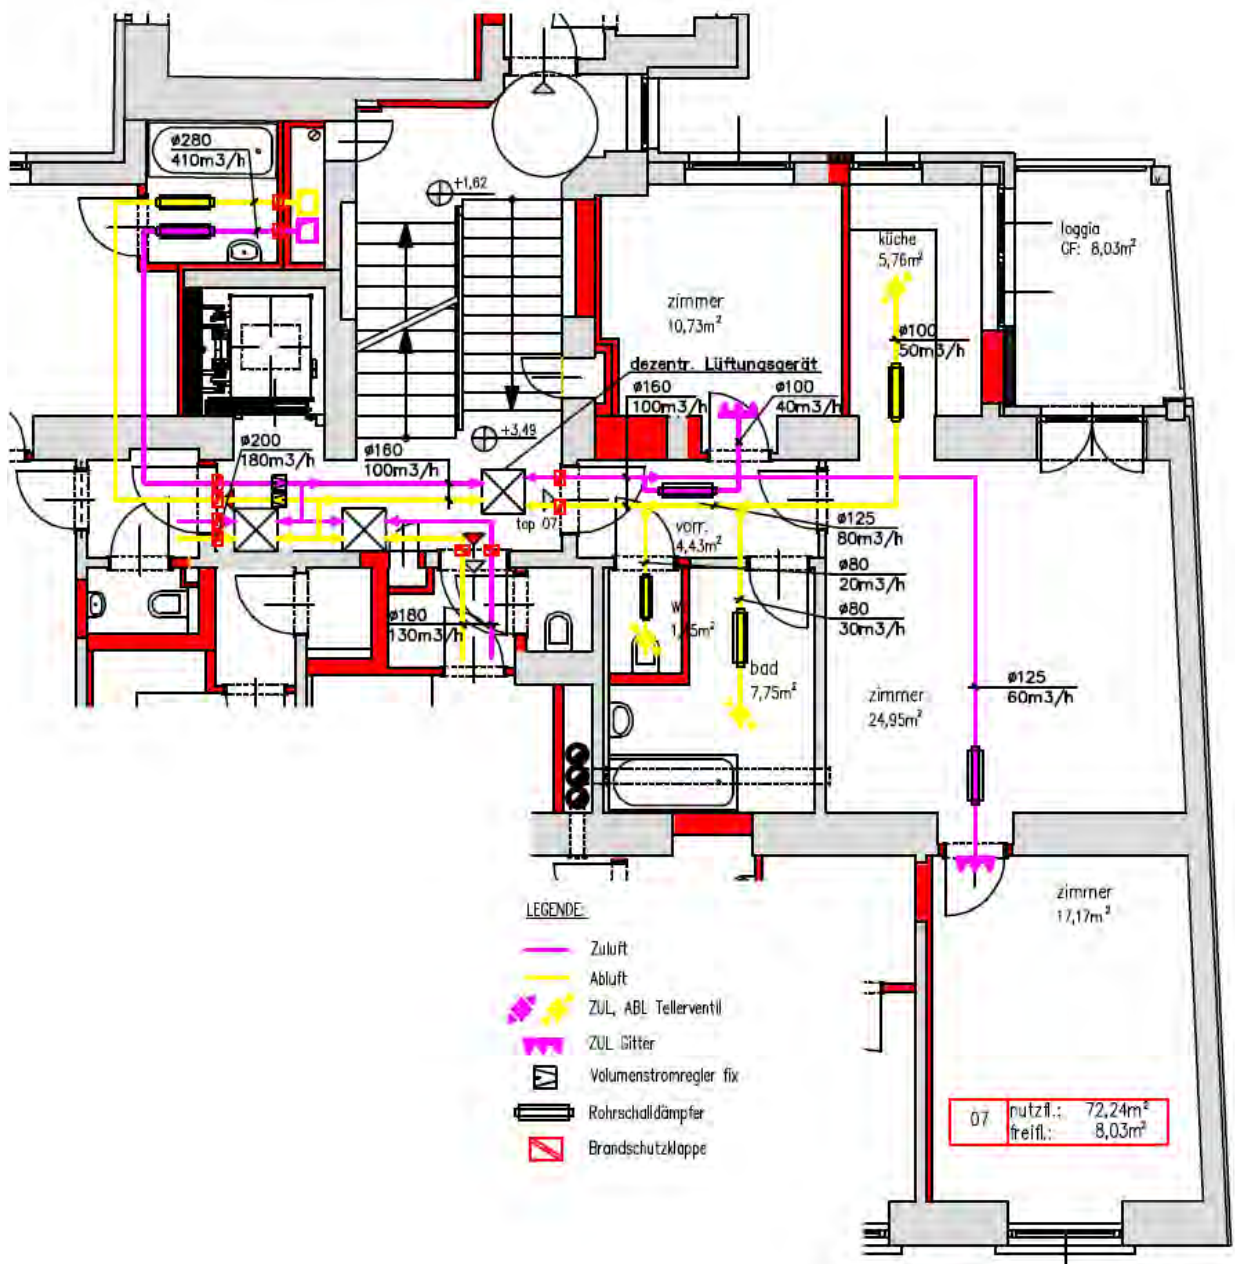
Grundrissdarstellung semizentrale Lüftungsanlage mit Kaskadenlüftung
